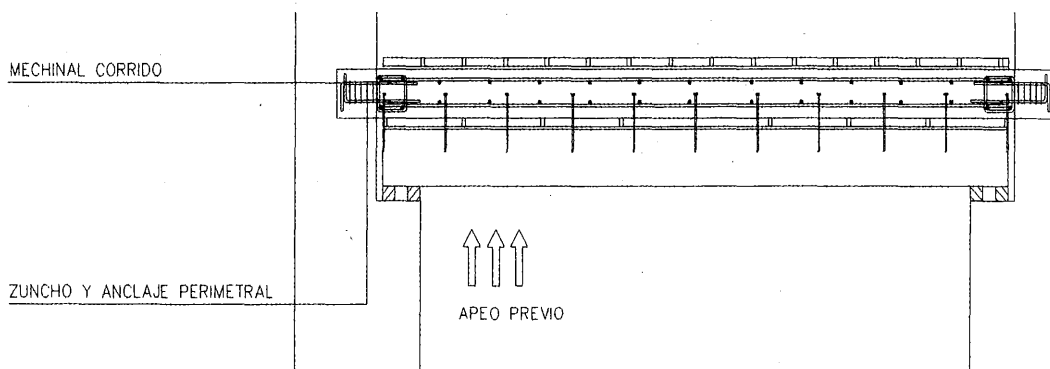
Sustitución funcional de forjados mediante la creación de losas de hormigón apoyadas perimetralmente.
